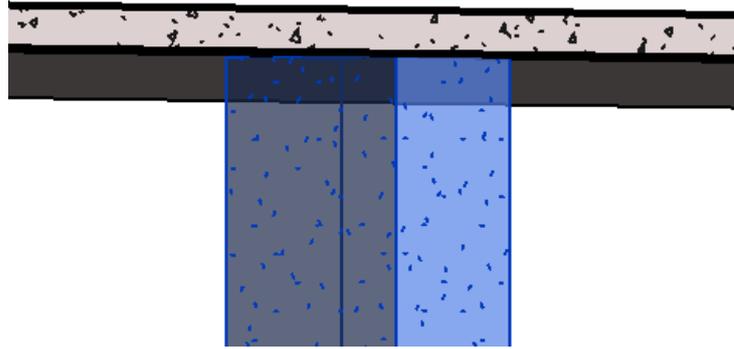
Columna ubicada debajo de losa luego de realizarse la corrección.
